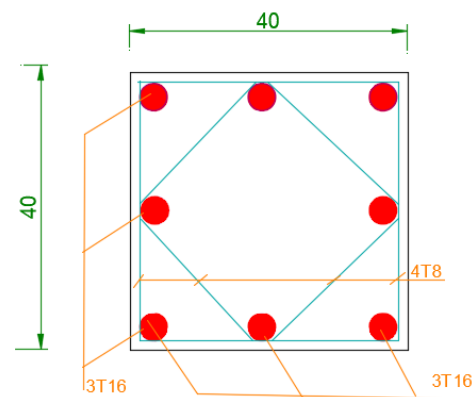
Schéma De Ferrailage Des Poteaux de 10^{eme} et 11^{eme} étages.
